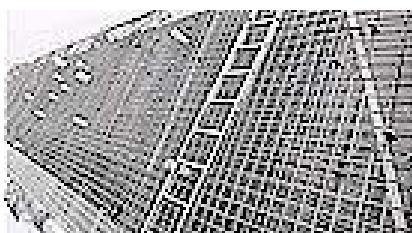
Estado de la obra en 1982. Fuente: FLC/ADAGP
